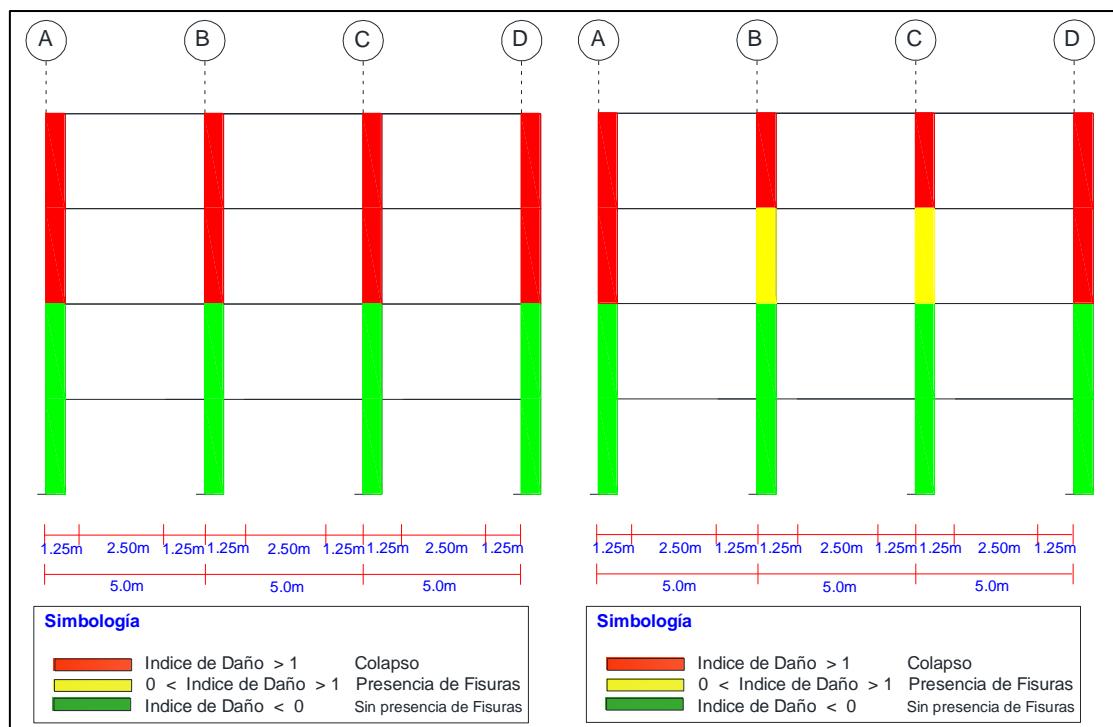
Representación daño en las Columnas – Pórtico 3 y Pórtico 2.
